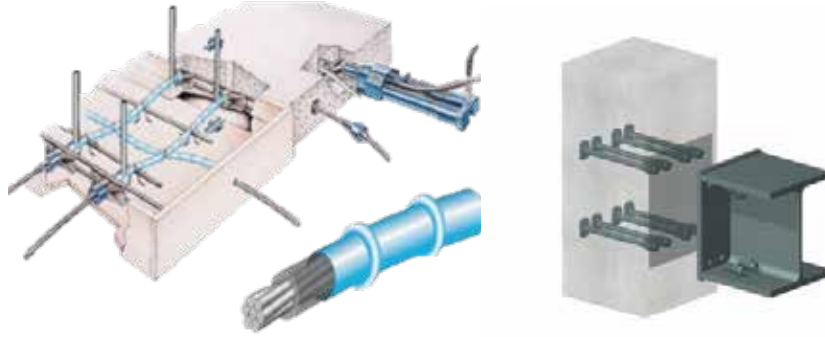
Vigas pretensadas. Figura23. columna de concreto y viga de acero.
